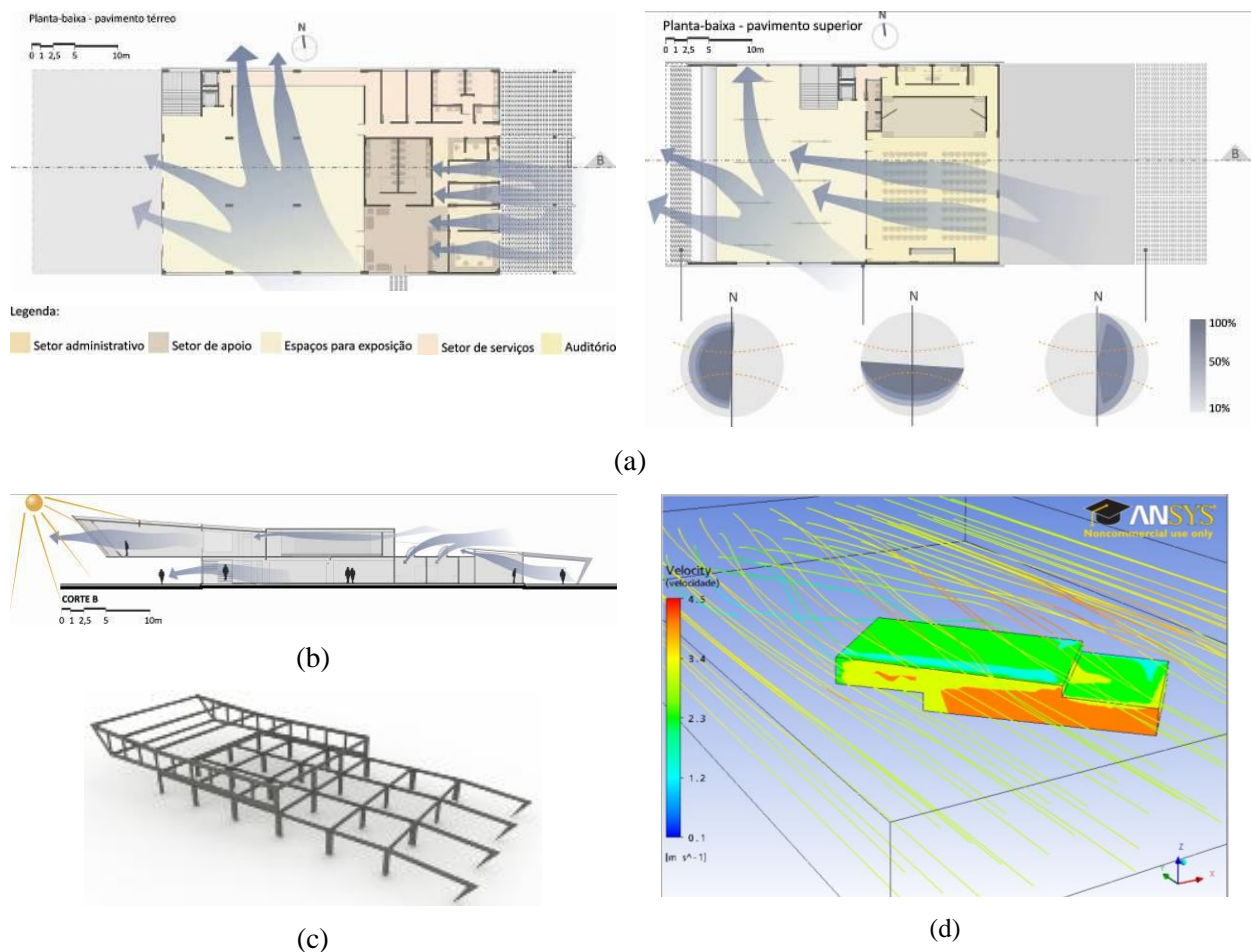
Plantas Baixas (a), Corte B (b), Esquema estrutural do Museu da Rampa (c) e Simulação da ventilação no software CF-x (ANSYS, 2007)
